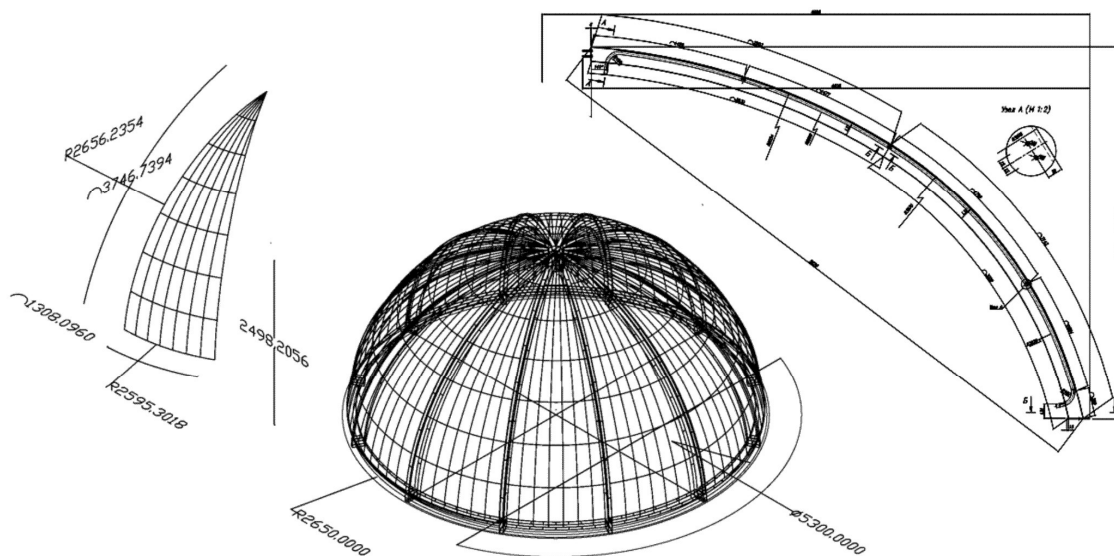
Пример конструкции сферического купола с размещением труб пожаротушения внутри несущего профиля из нержавеющей стали
